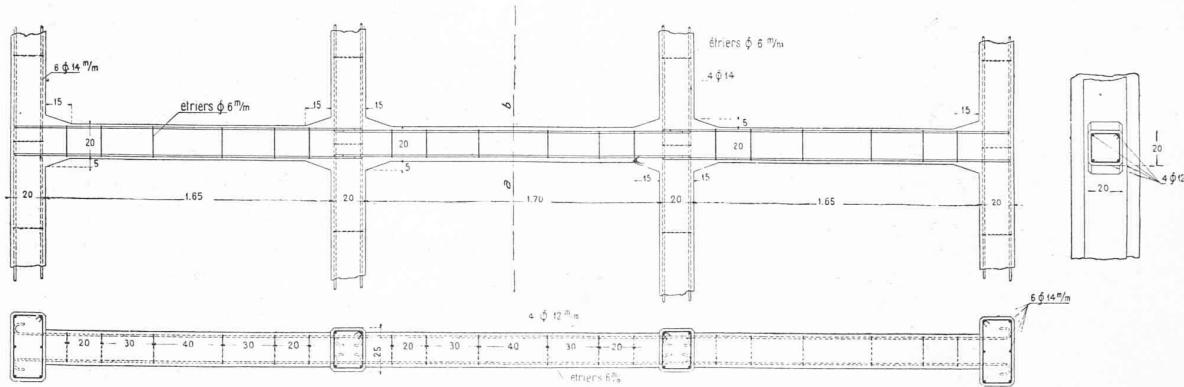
Poutres transversales des colonnes de la chaussée. — 1 : 40.
